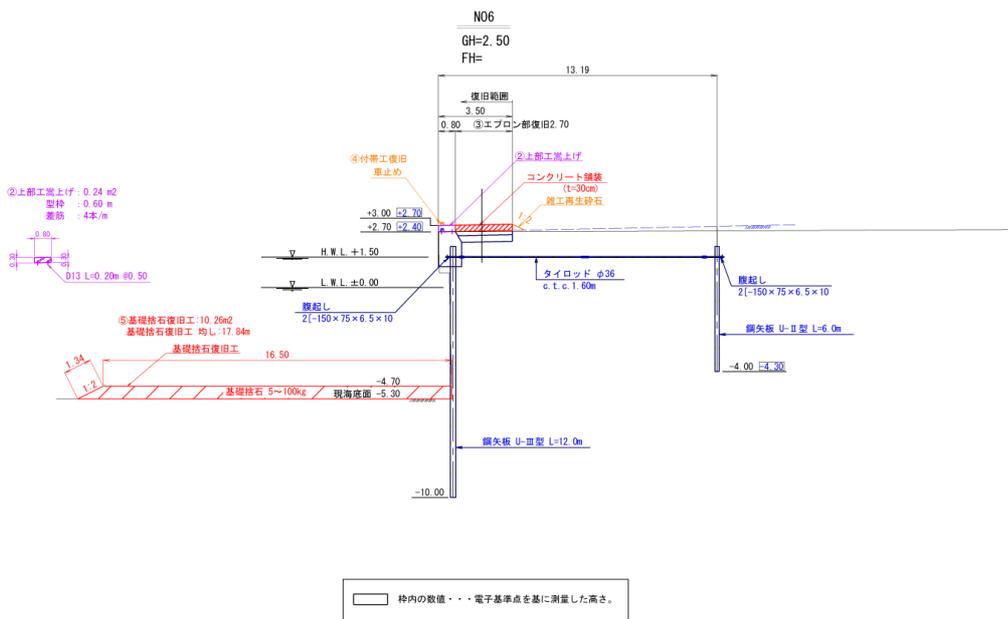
No.14 日立港区_第5埠頭地区第1船だまりの断面図(取付部)(復旧後)
